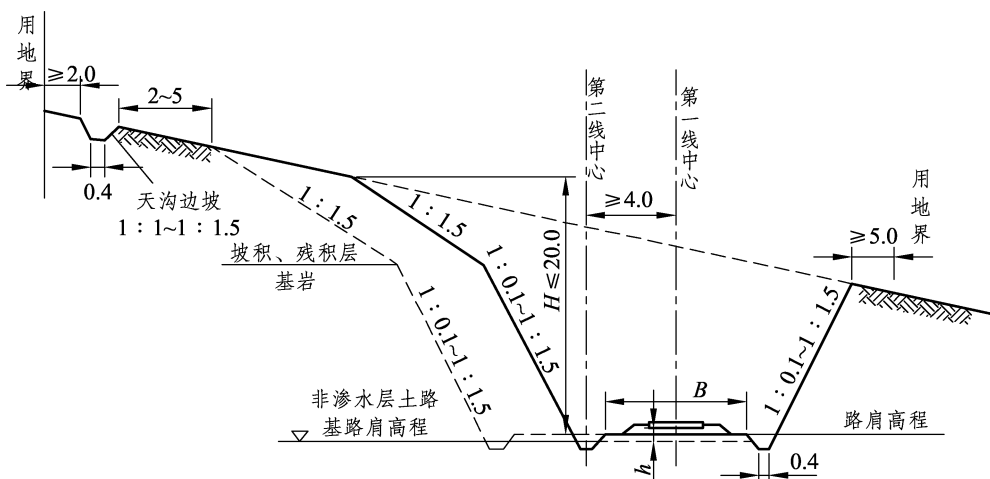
有排水沟岩石路堑典型横断面图 (单位: m)
